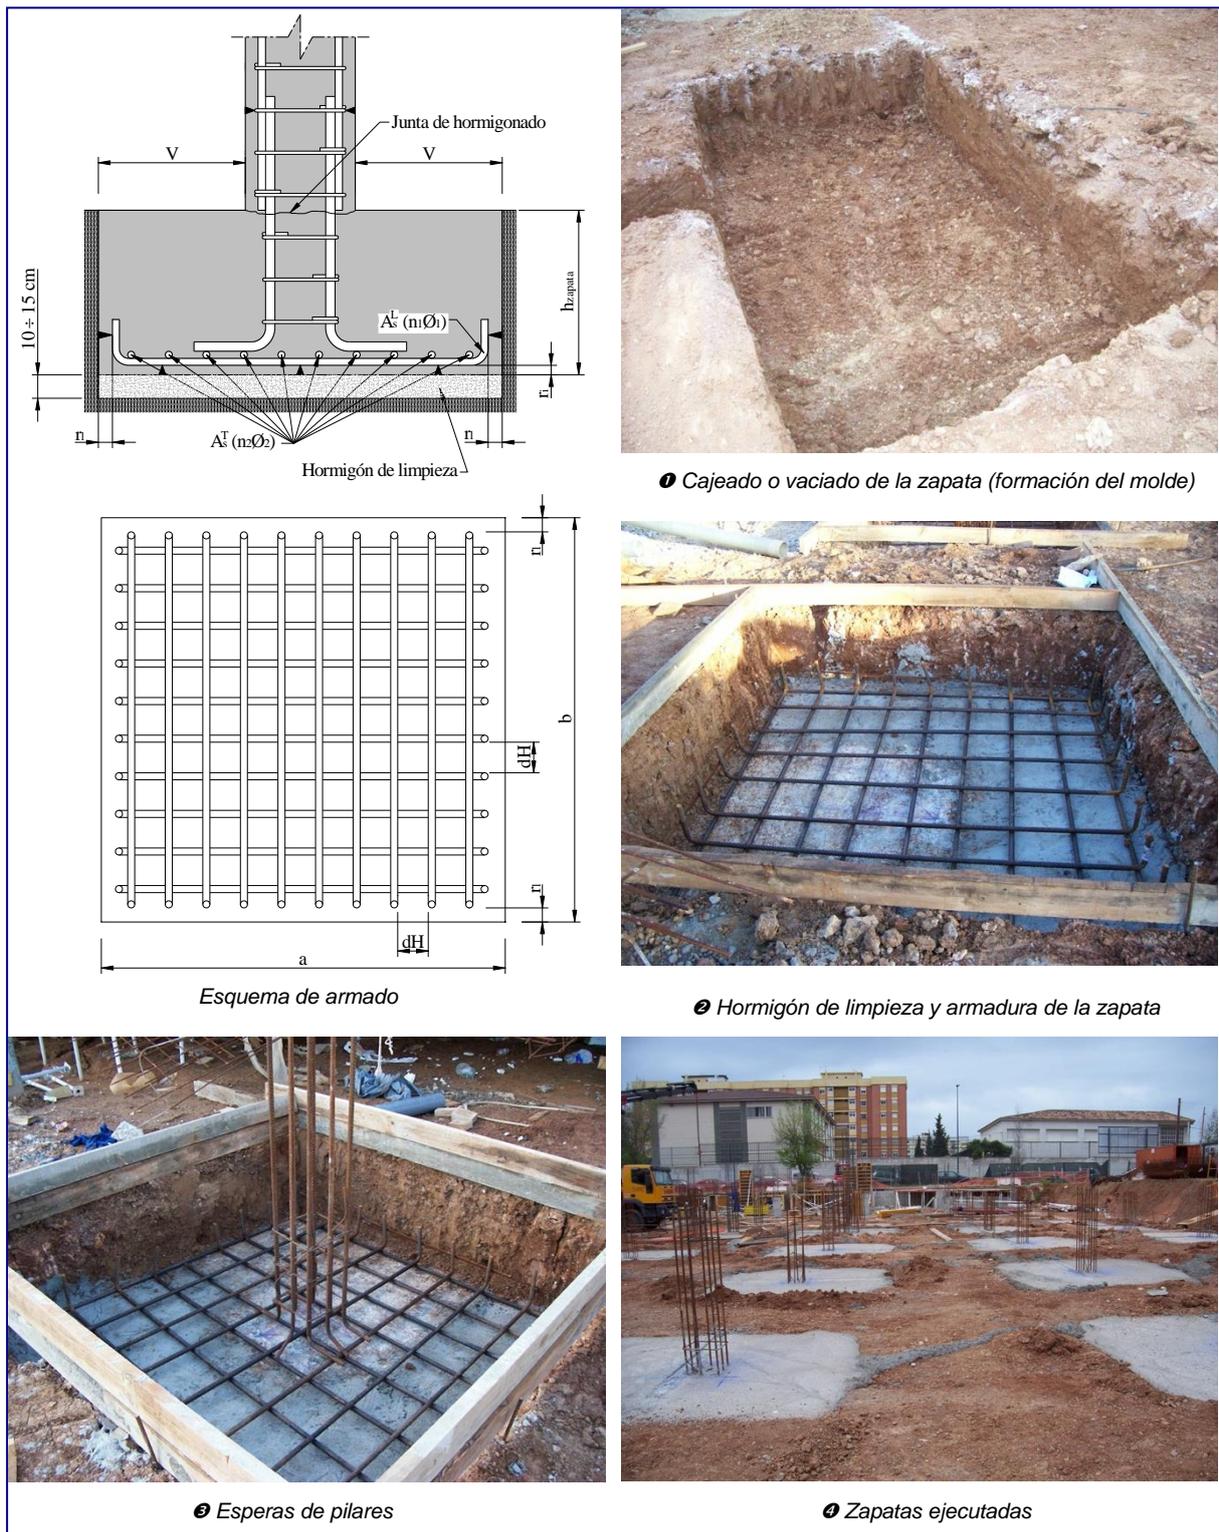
Esquema de armado de zapatas y su proceso de ejecución (Puede visualizarse un armado típico en el siguiente link: <https://skfb.ly/ottS8>)
